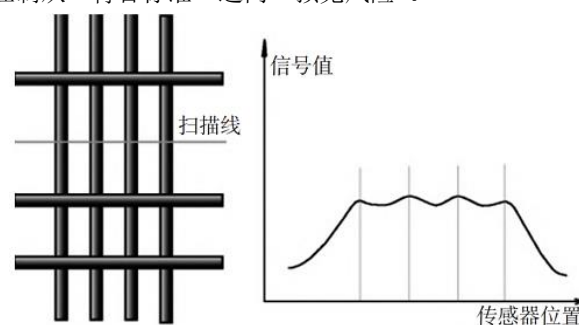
钢筋位置及保护层厚度检测磁场聚焦示意图
